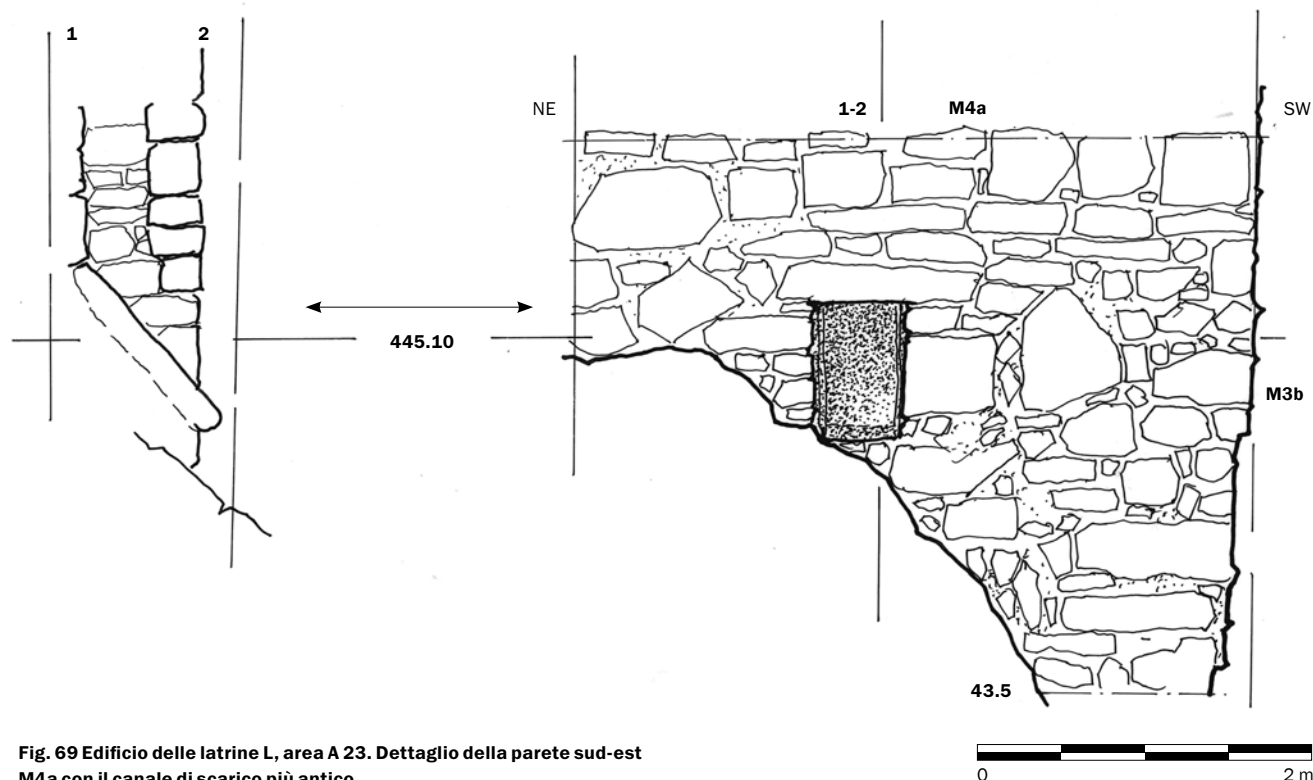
Edificio delle latrine L, area A 23. Dettaglio della parete sud-est M4a con il canale di scarico più antico.
